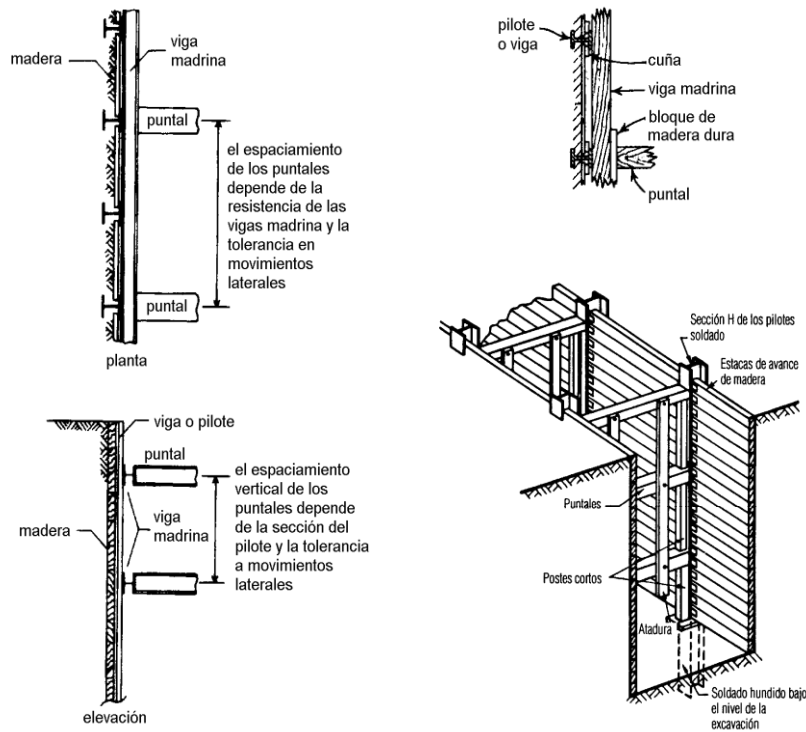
ESQUEMA GENERAL DE MURO BERLÍN: VIGAS, MADERA Y PUNTALES
